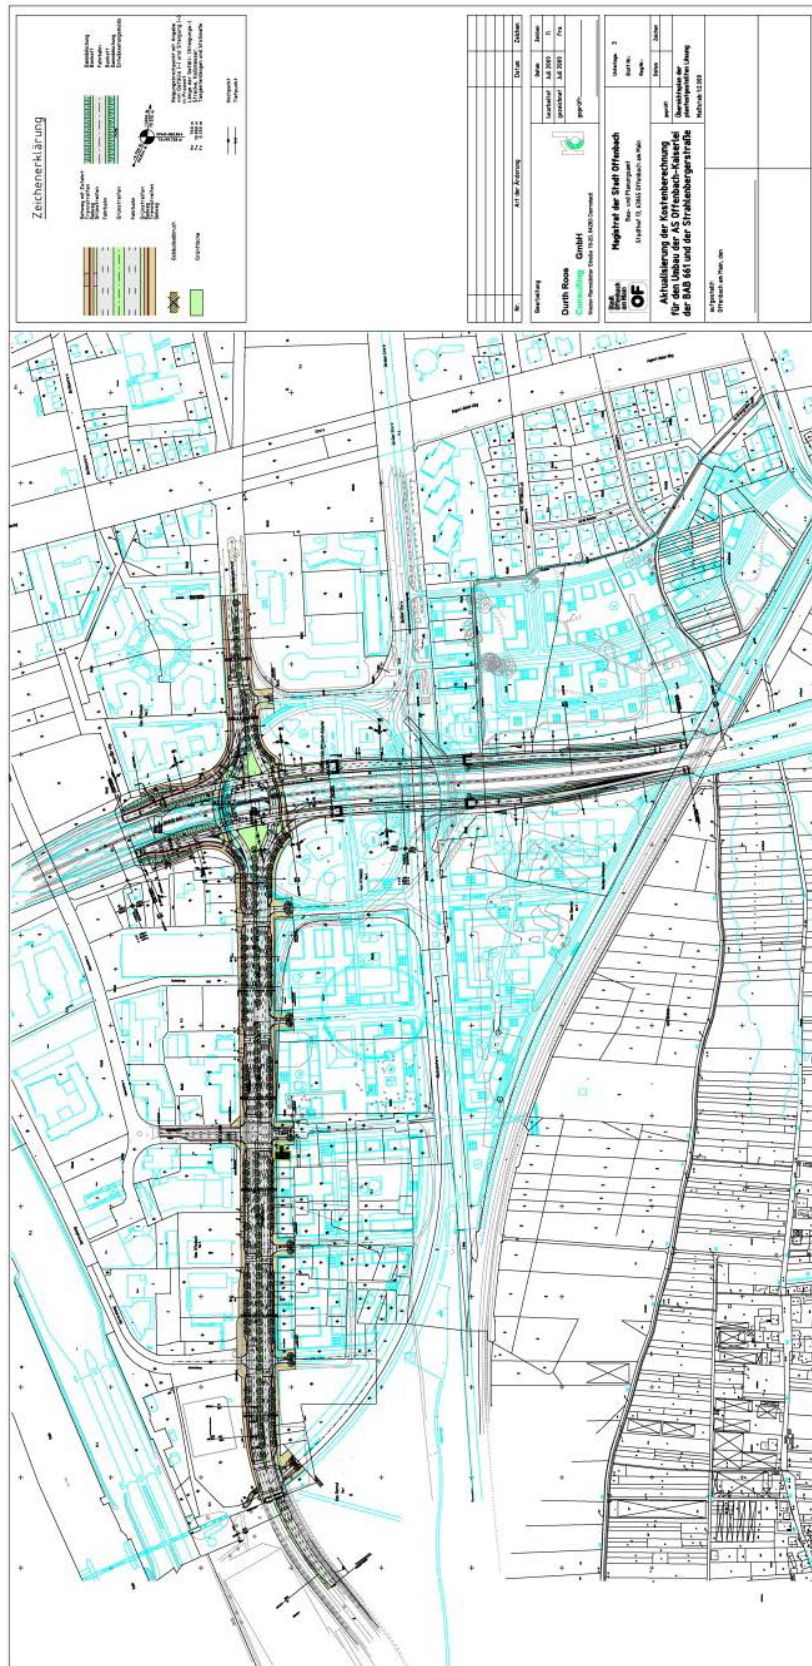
Planfeststellung Umbau BAB 661 AS Offenbach Kaiserlei
